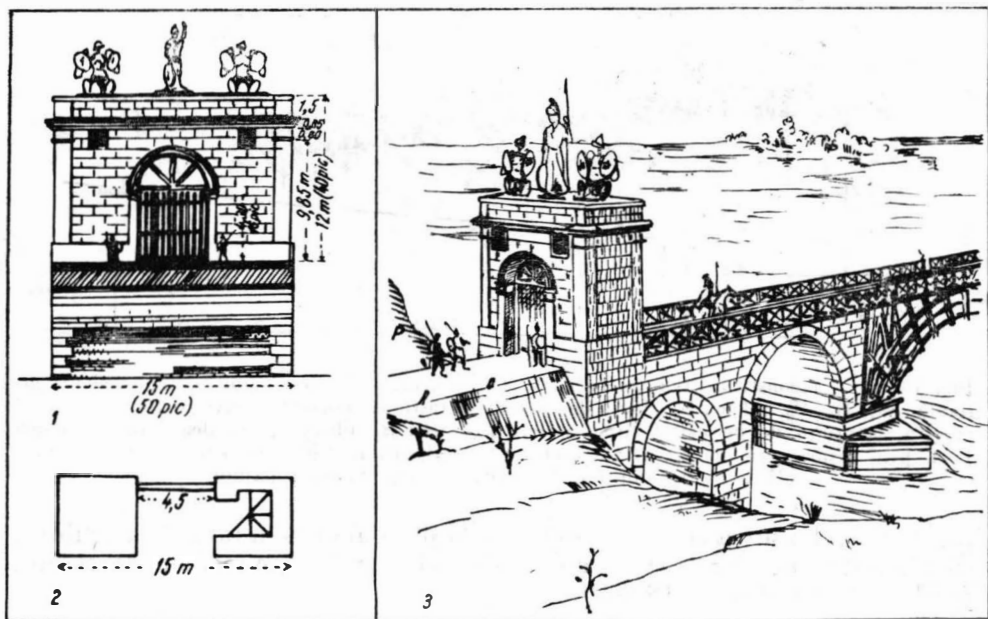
1, elevația portalului cu două camere la etaj; 2, camerele de la etaj cu scară de acces; 3, ultimele bolți, portalul și șoseaua paralelă cu panta (P) de la vest de castru (după Duperrex).
